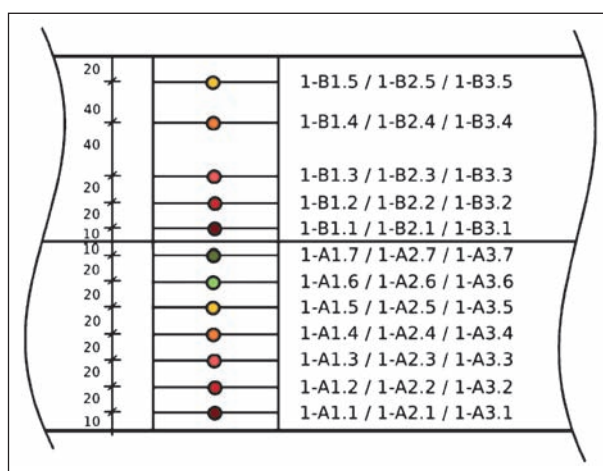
Soll-Einbauzustand sowie Bezeichnung der Thermo-elemente Probekörper HT 1
